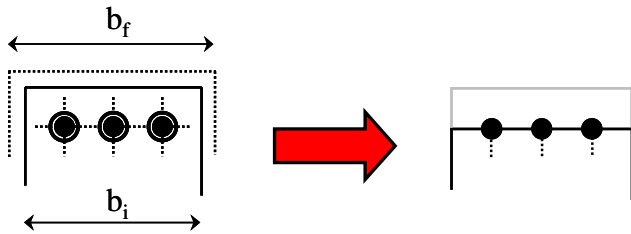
Fessurazione da splitting e successivo spalling.
